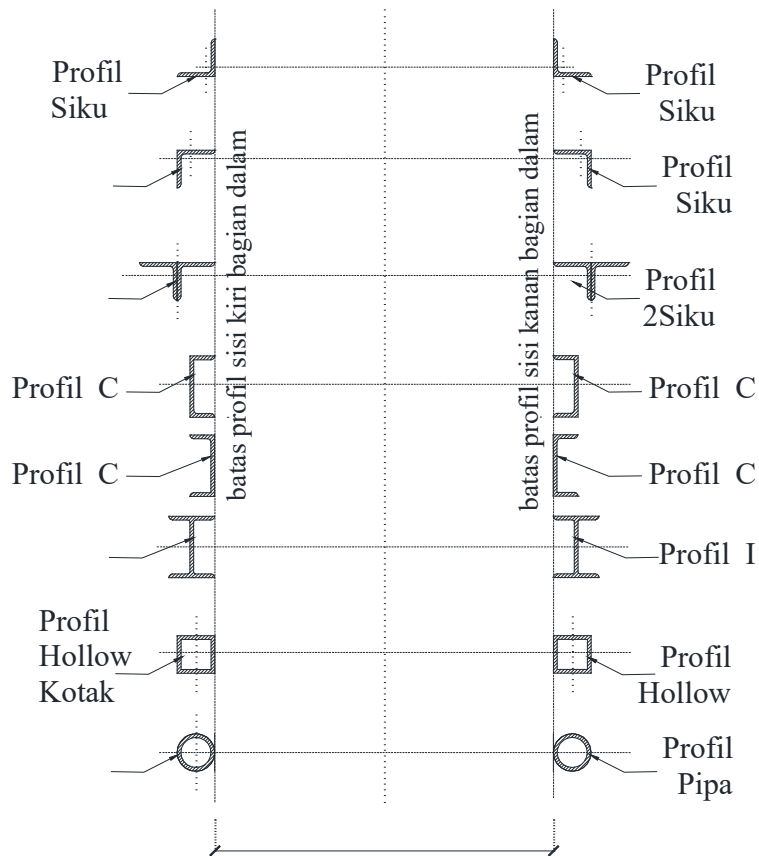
Contoh Pengukuran Tinggi Jembatan Pada Berbagai Jenis Profil Baja (tambahan)
